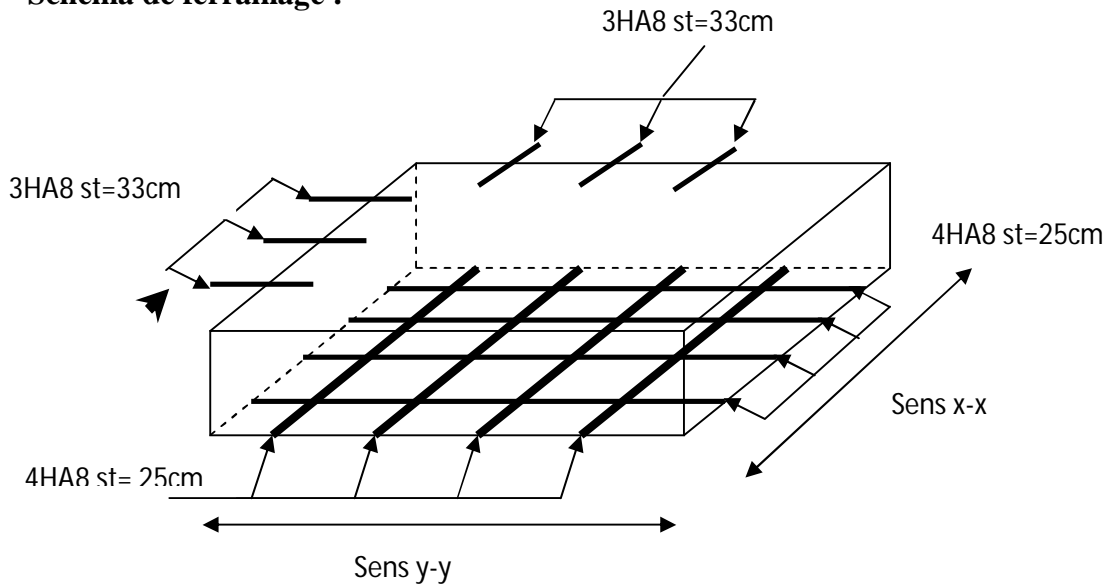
Schéma de ferrailage de la dalle sur deux appuis
